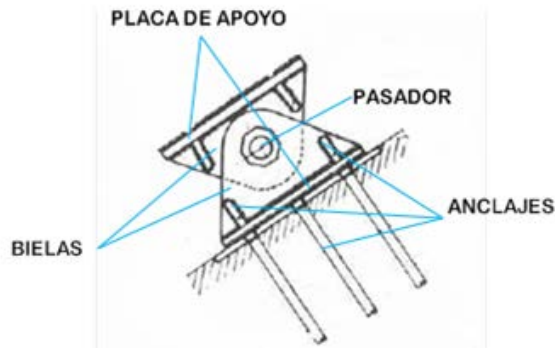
Dispositivo para lograr un enlace óptimo entre la cercha metálica y la estructura de concreto reforzado.
